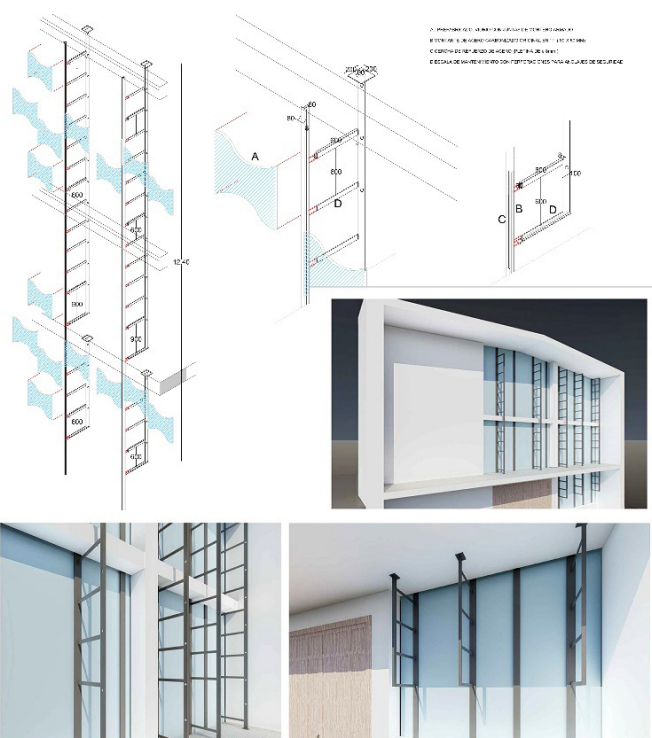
Infografías de la vidriera tras la intervención. Estructura metálica y cercha de refuerzo estructural
